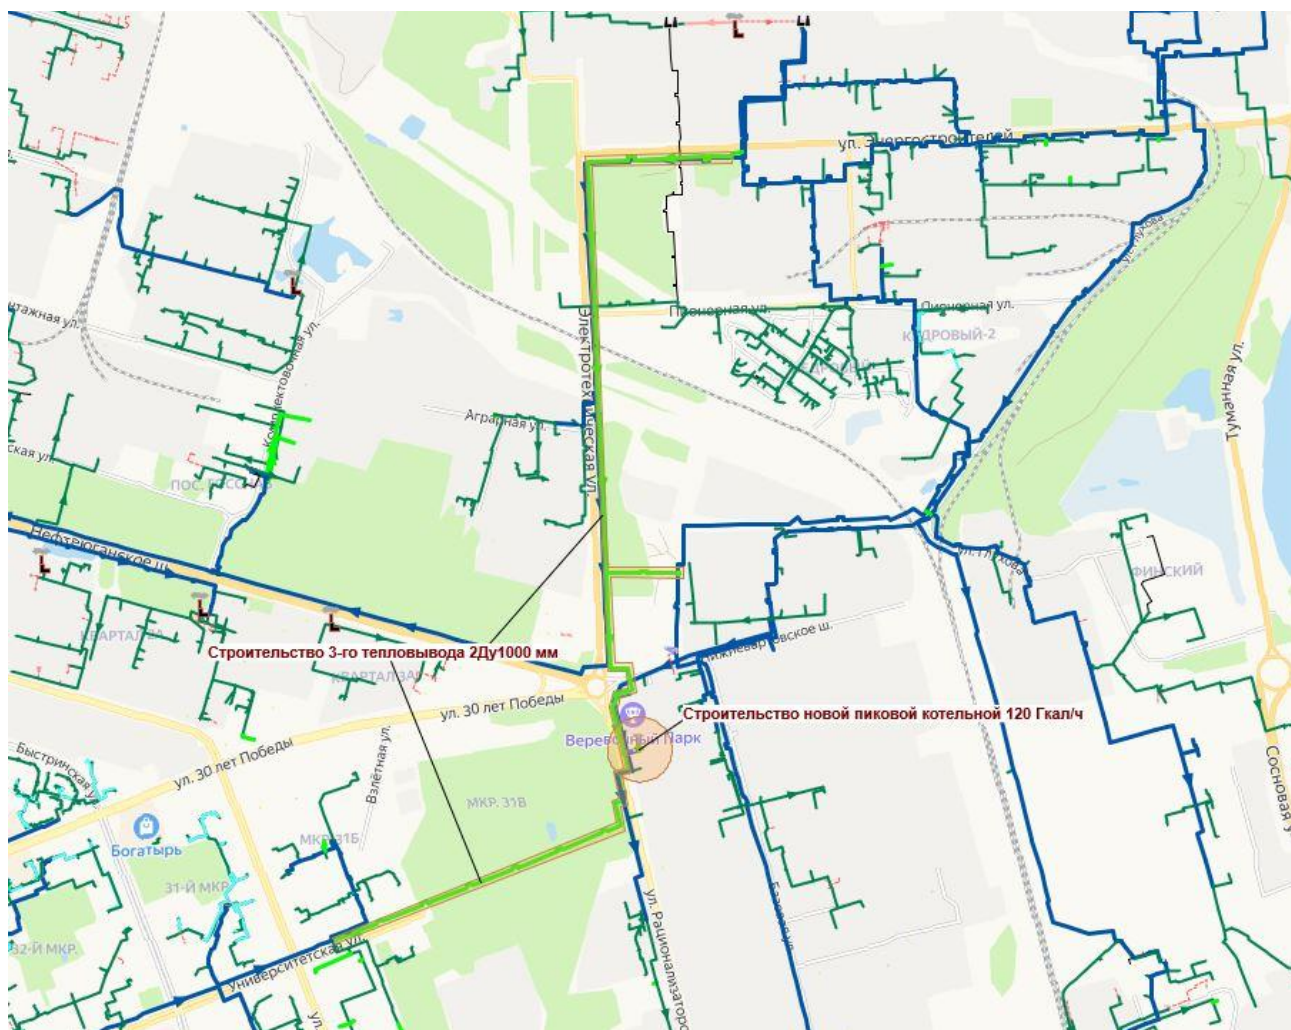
Схема расположения планируемого 3-го тепловывода
